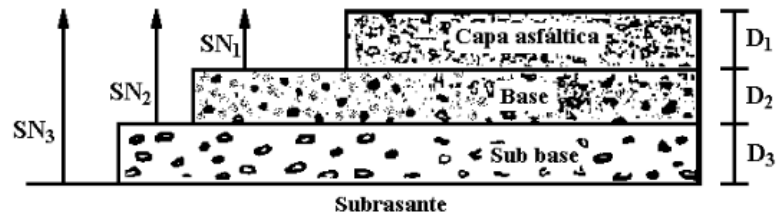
Números estructurales y espesores de las capas de un pavimento flexible
